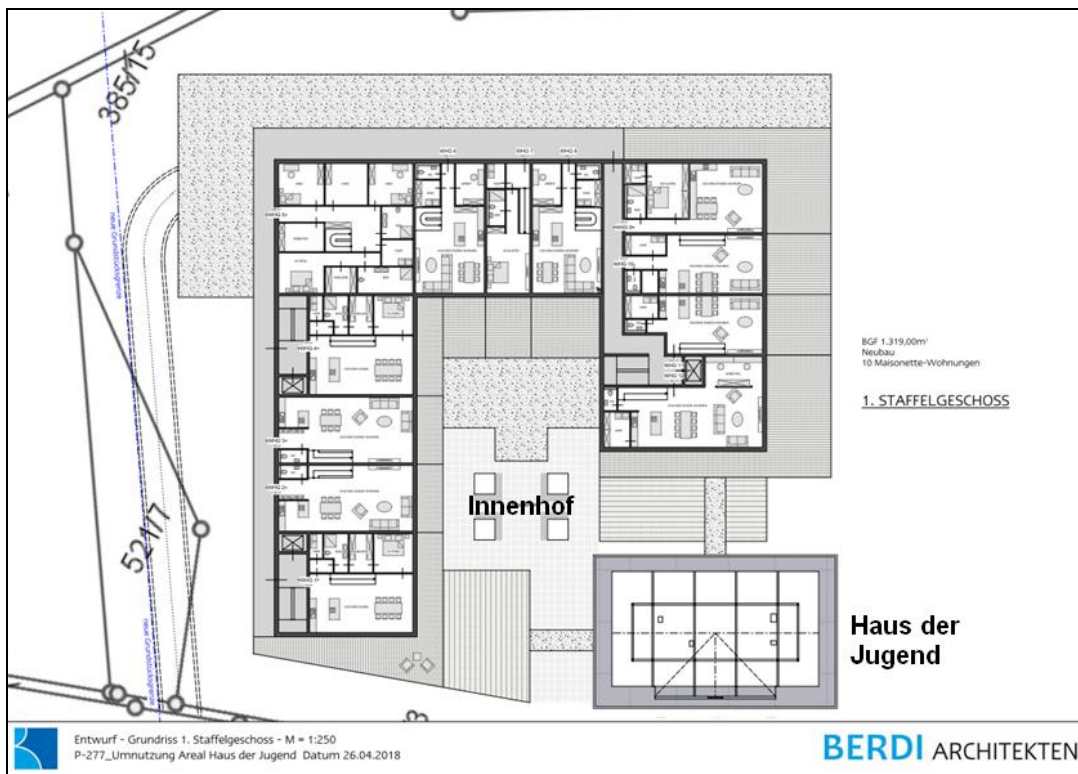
Grundriss 1. Staffelgeschoss (Maisonette-Wohnungen)
